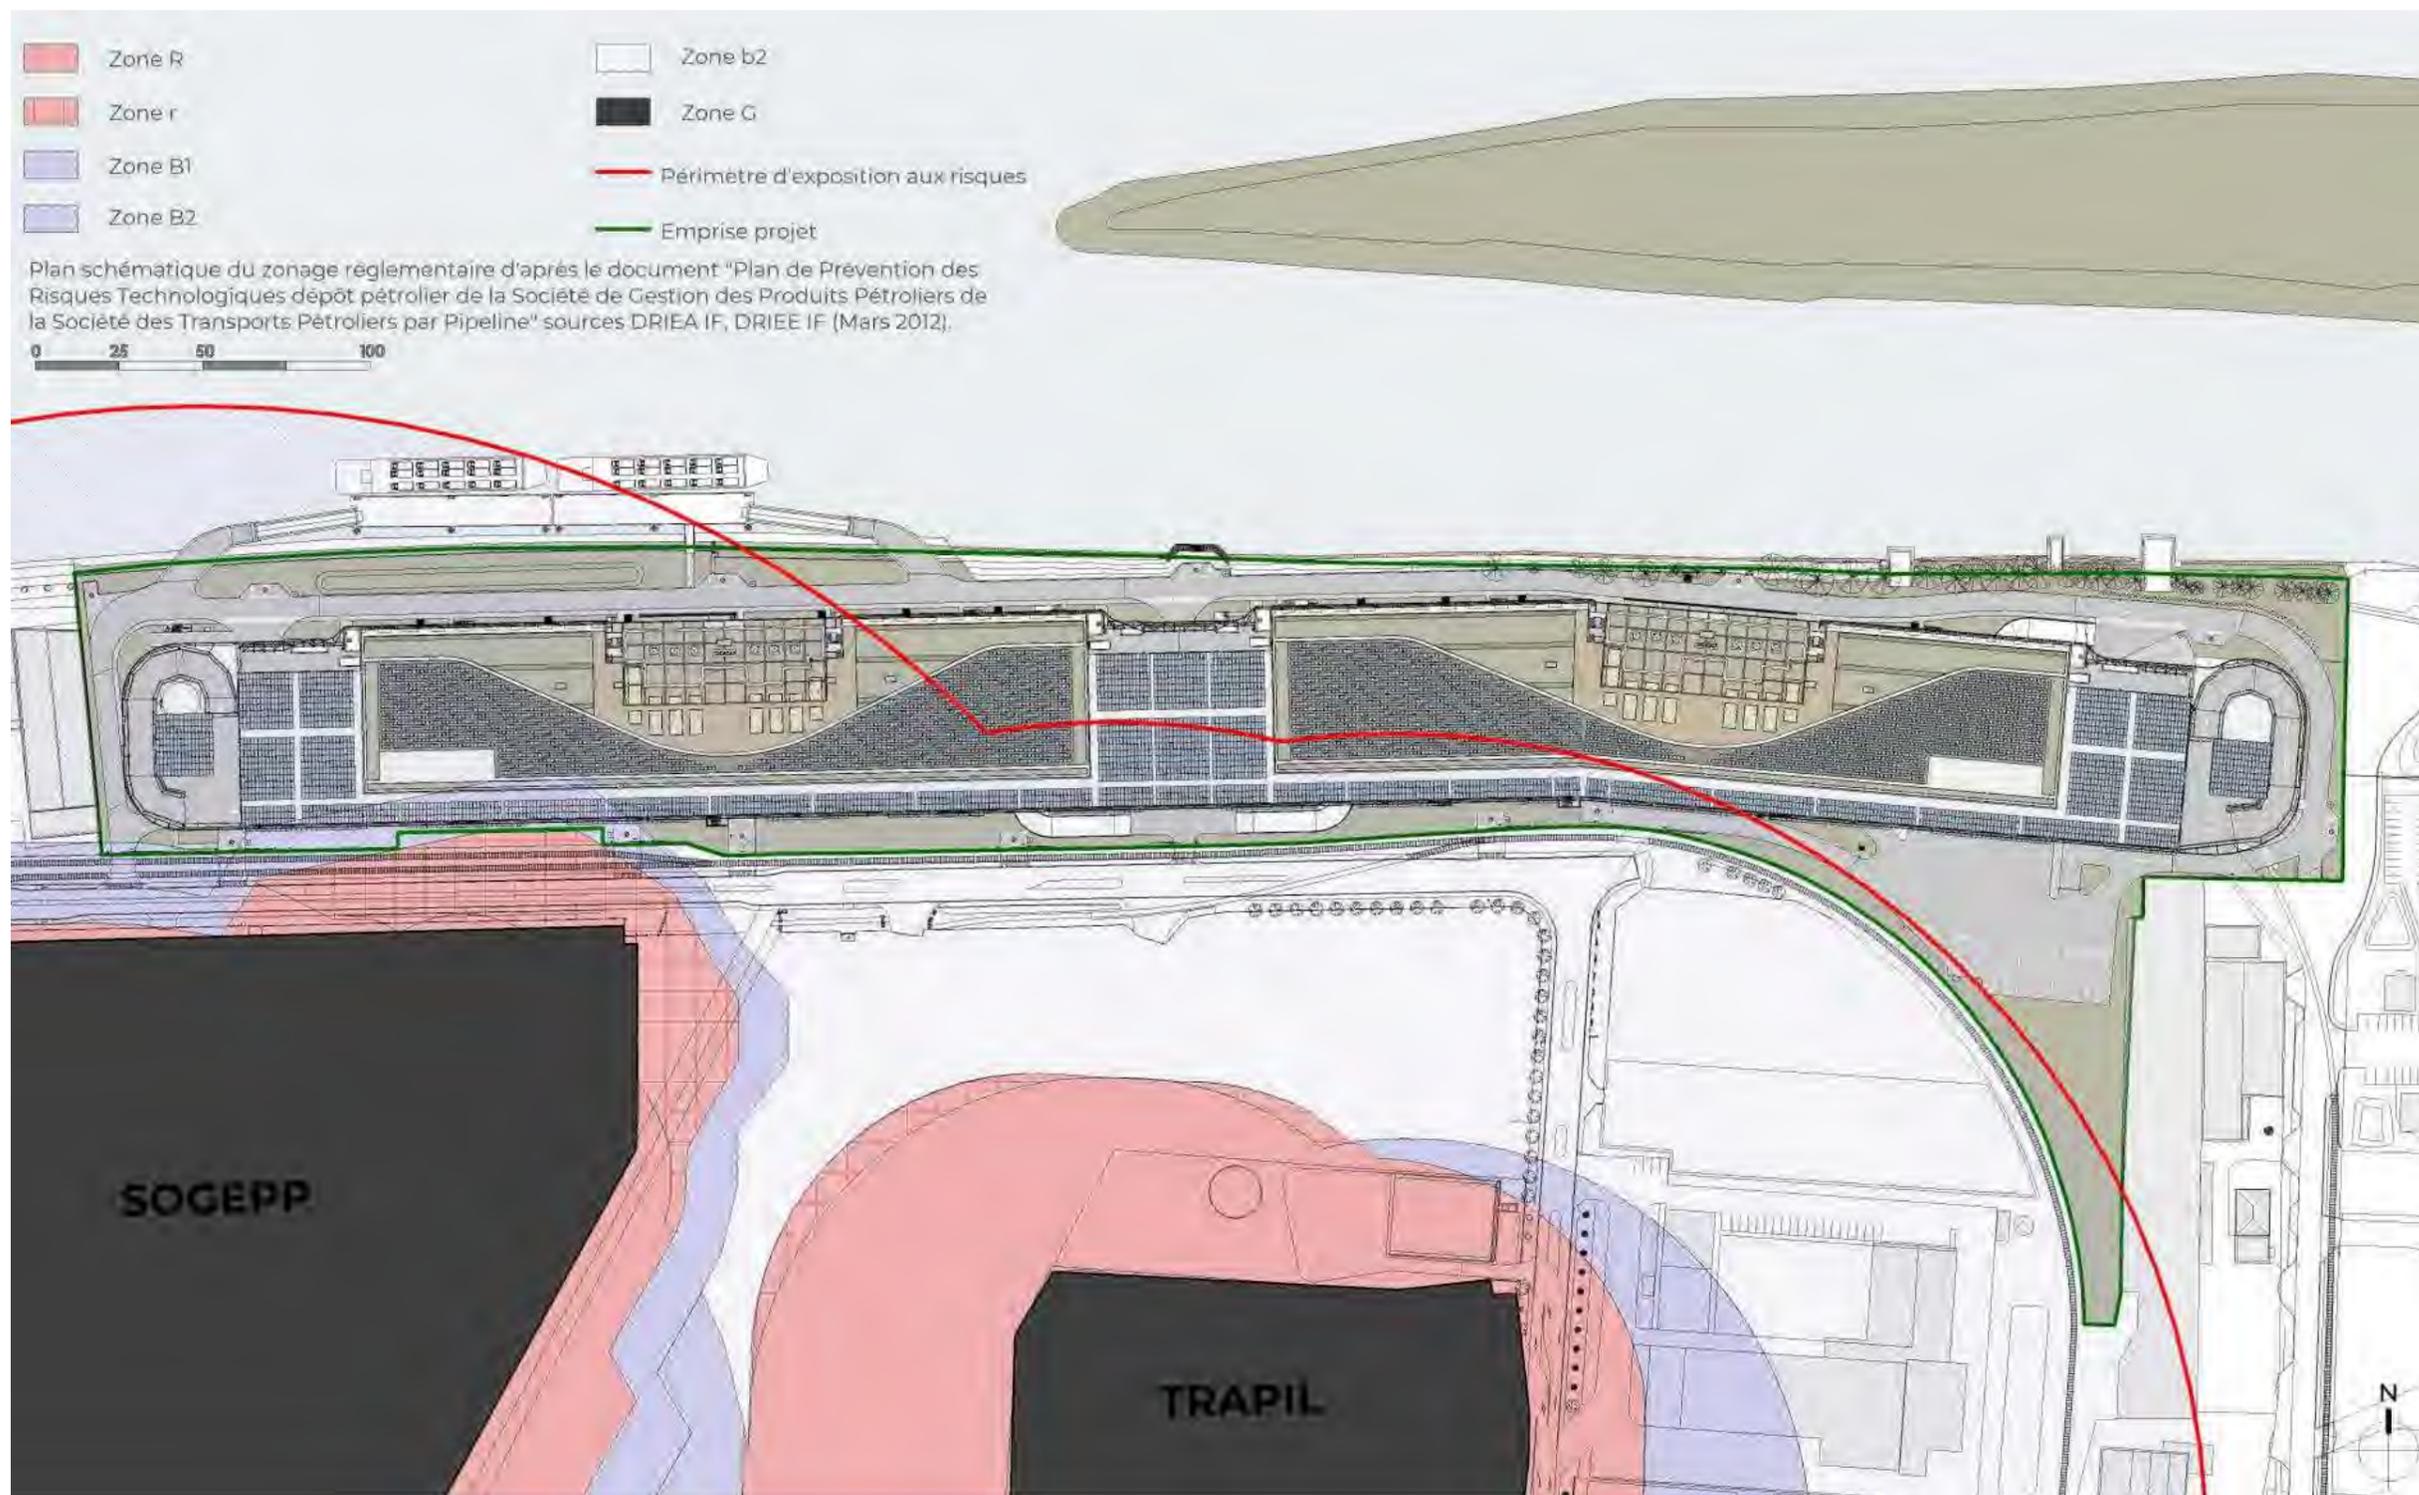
Localisation du projet sur un extrait de plan de zonage PPRt (source : A26)
